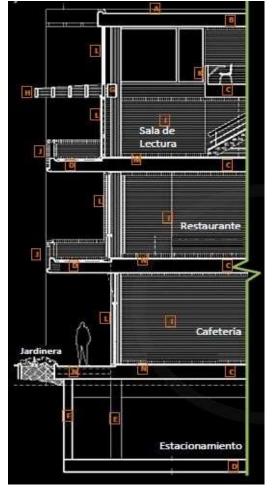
Sistema constructivo estructural Fuente: Panoramio.com
